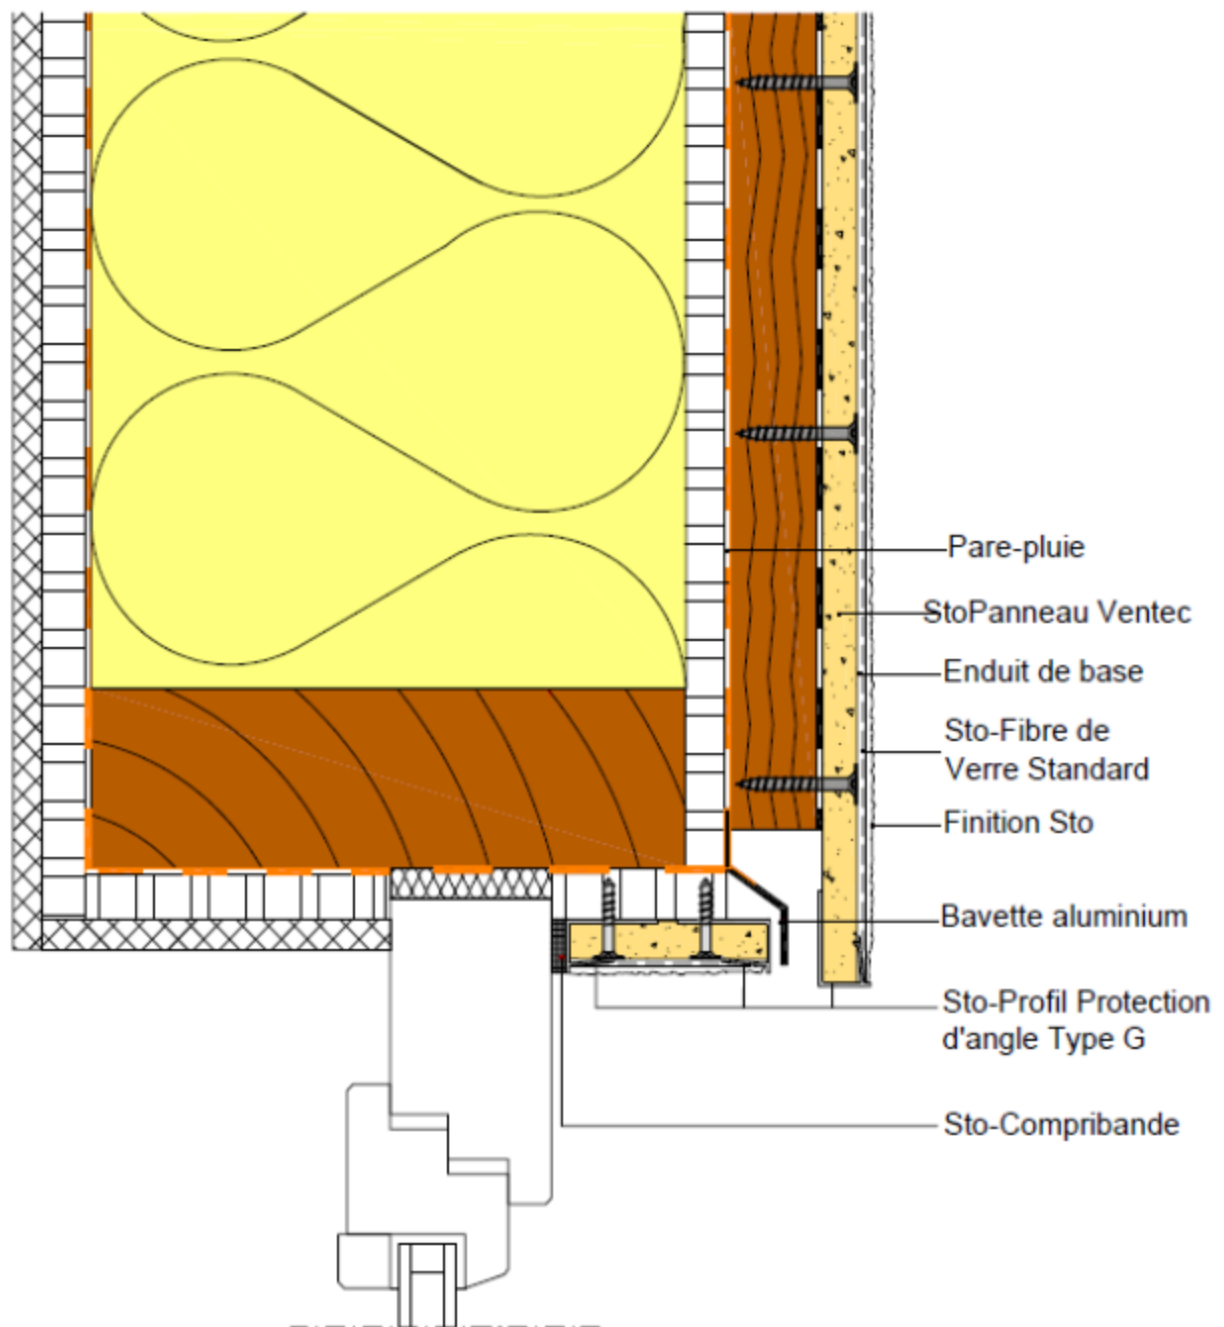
Coupe verticale - Menuiserie posée en tunnel - Traitement de linteau non isolé en retour de parement - Ossatures bois sur COB
